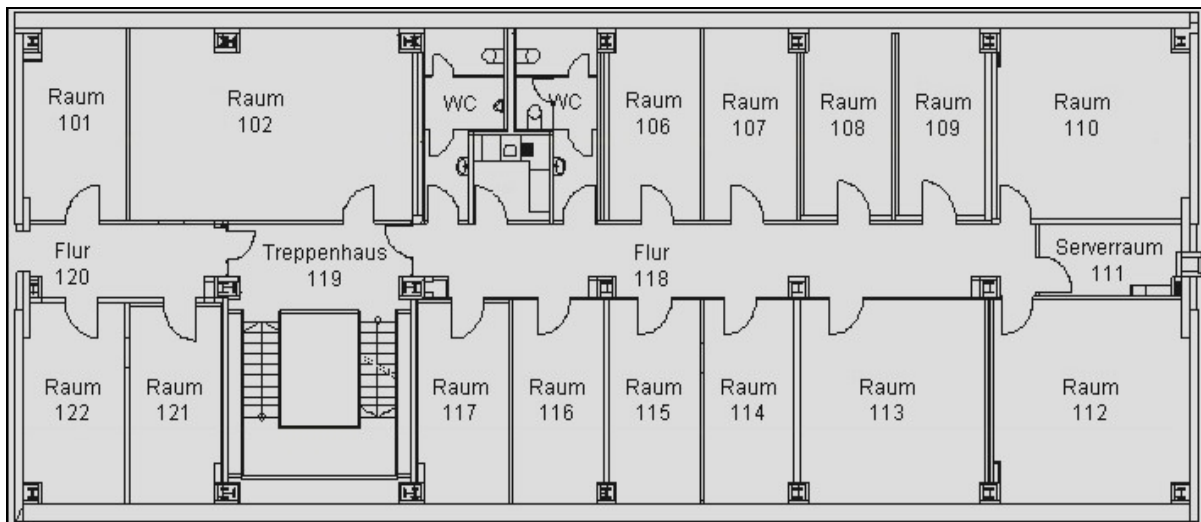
Grundriss 1. Obergeschoss
